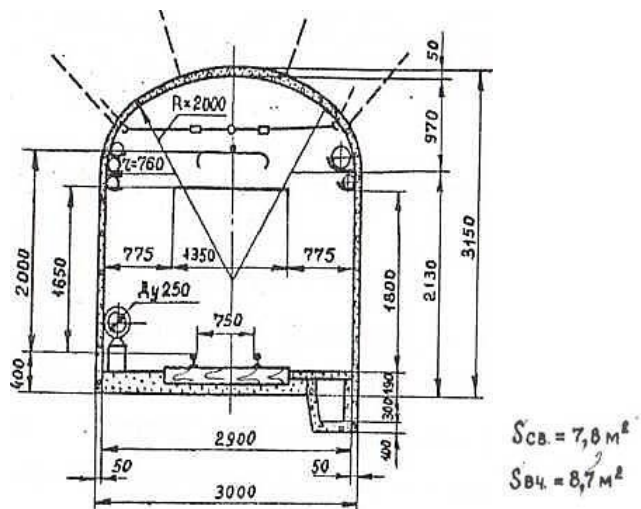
Сечение выработки, закрепленной железобетонными штангами с затяжкой кровли металлической сеткой
